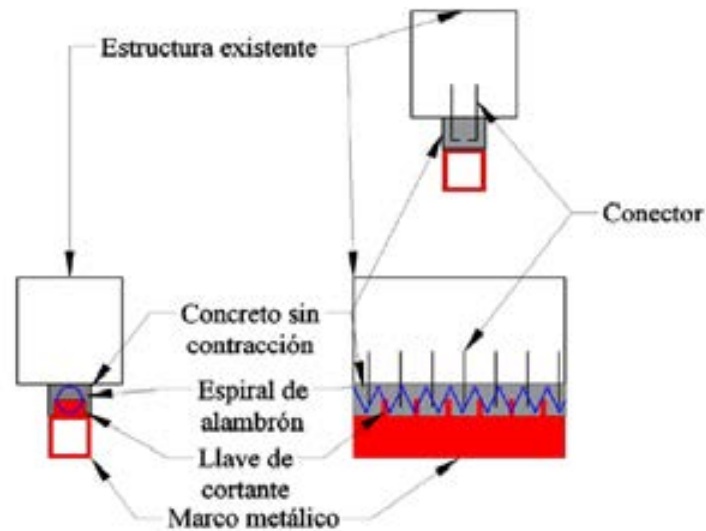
Corte longitudinal del marco de conexión con la estructura existente mediante concreto de baja contracción
